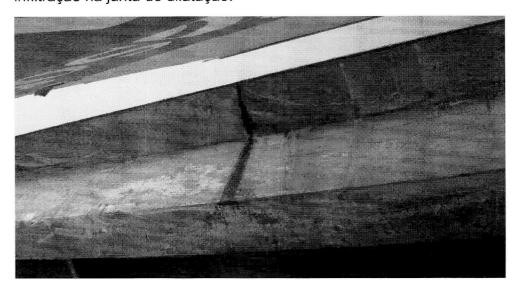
Detalhe da face inferior da viga com armadura exposta e infiltração na junta de dilatação.
